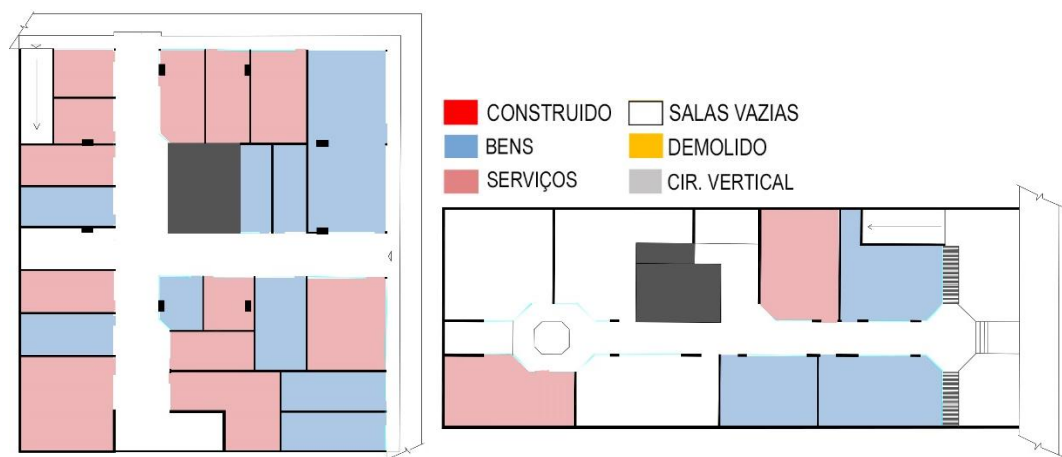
Planta baixa: 1G e 1H, respectivamente.
